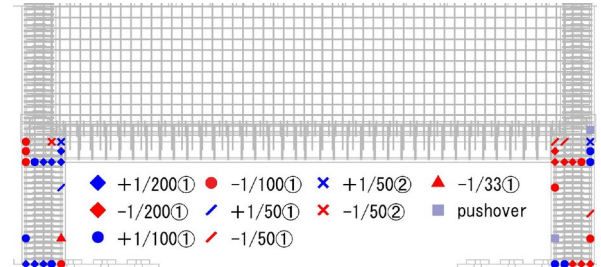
ひび割れ図 ($R_1=1/100(\text{rad})$)
